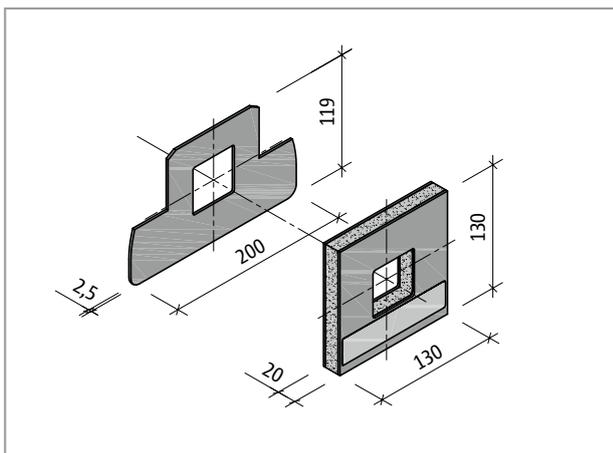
Schöck Tronsole® Typ P: Brandschutz-Set bestehend aus Brandschutzabdeckung ($t = 2,5$ mm) und Brandschutzmanschette(n)
